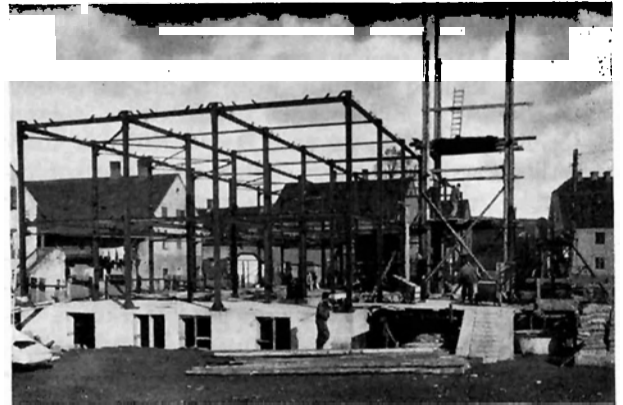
Fertig montiertes Stahlskelett der beiden unteren Geschosse
